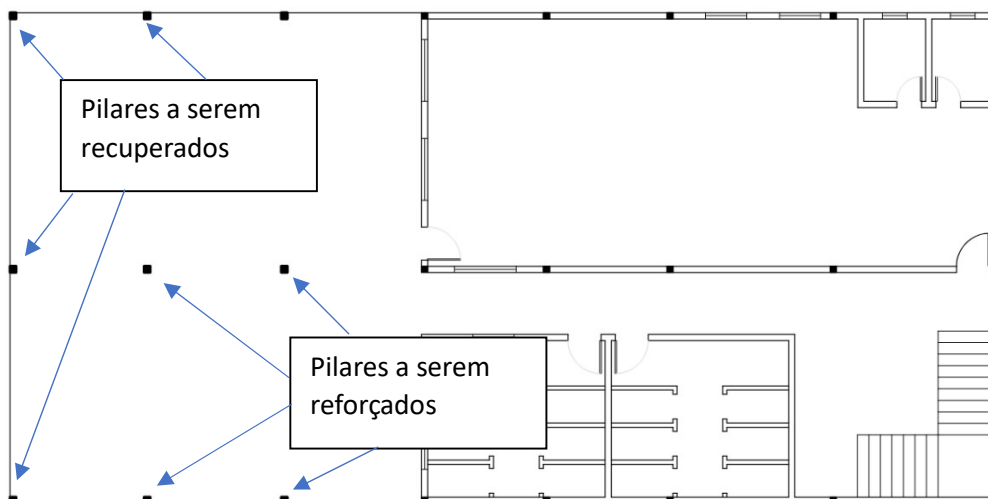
planta do pavimento térreo da escola com identificação dos pilares a serem recuperados e reforçados.
